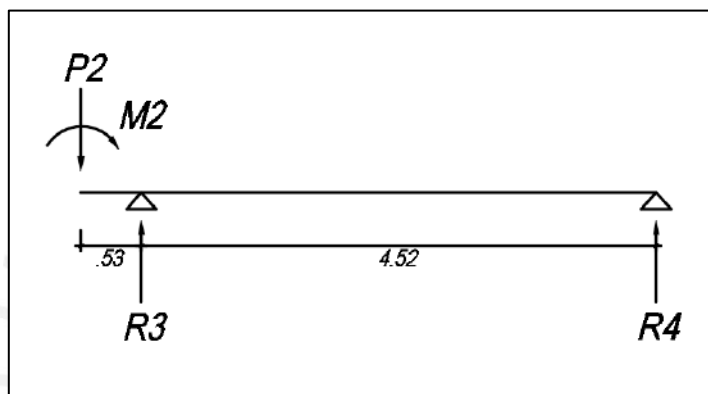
Modelo estructural en metros de las zapatas conectadas Z-07 y Z-08
